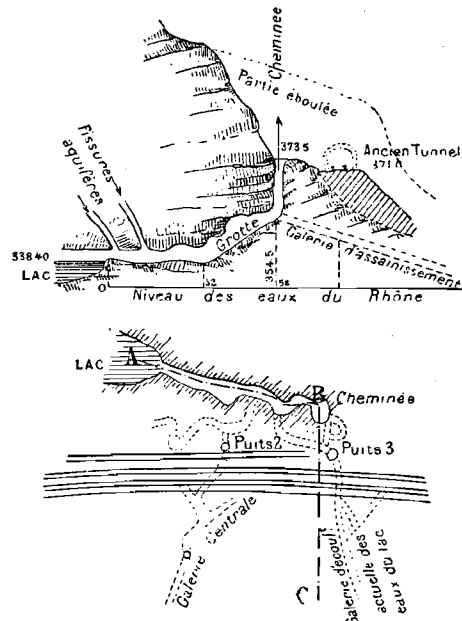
et 3. — Plan de la grotte et coupe longitudinale suivant A B C.
